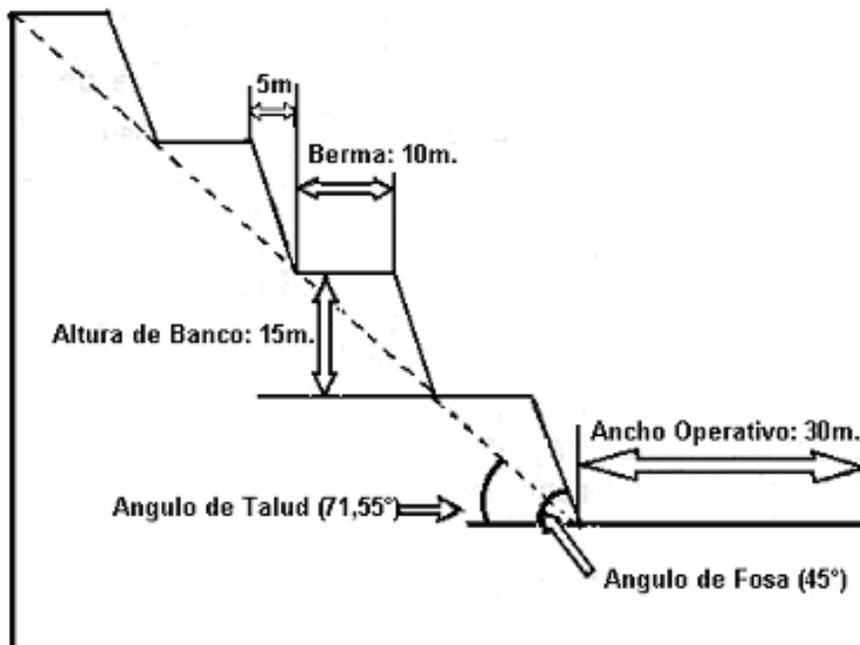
Parámetros para el Diseño de Fosa de Excavación
